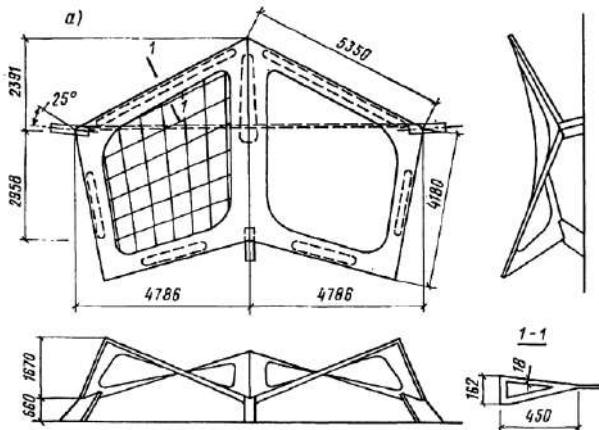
Монолитная железобетонная оболочка плавательного бассейна в Гамбурге. Конструктивная схема оболочки
